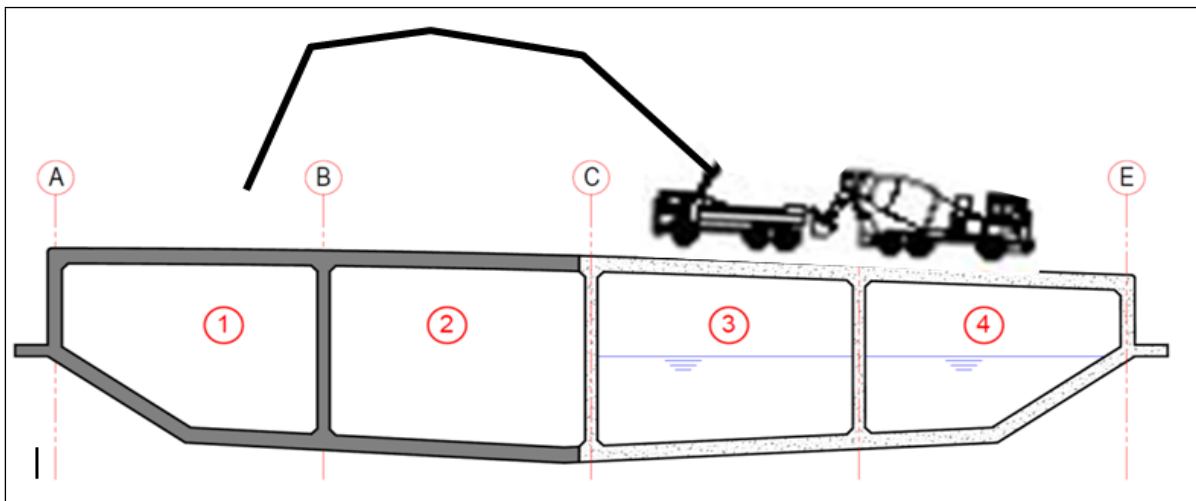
Fundida 2da. Etapa. Fuente: Construcciones Planificadas. SDA, 2016.
